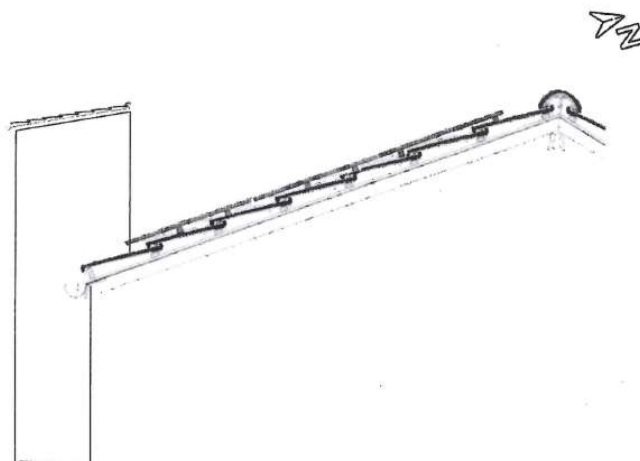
Exemple 2 - Plan de coupe sur toiture inclinée
